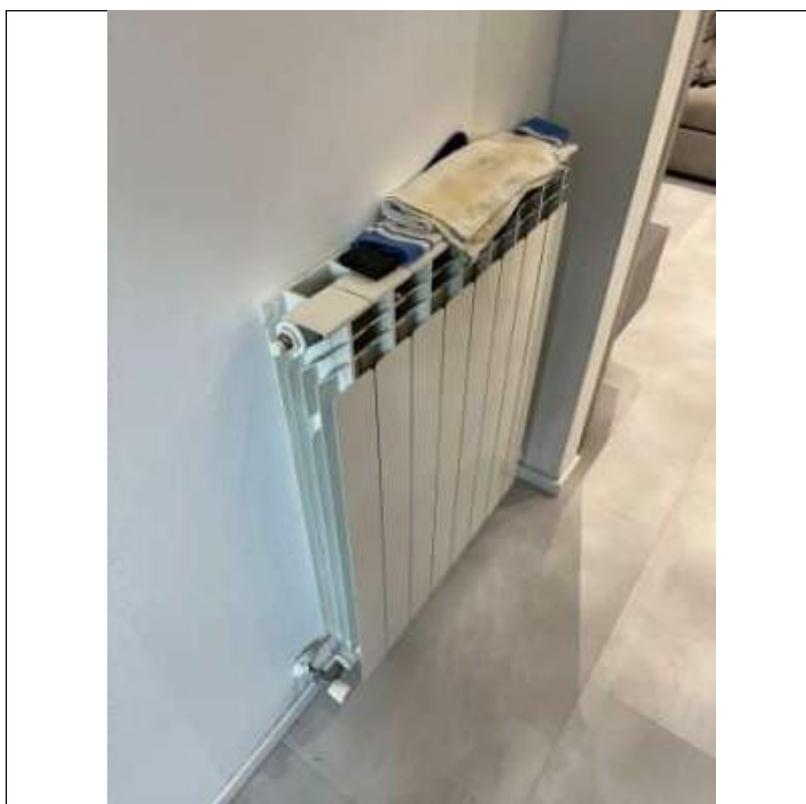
bene 1F appartamento, radiatori impianto di riscaldamento autonomo
